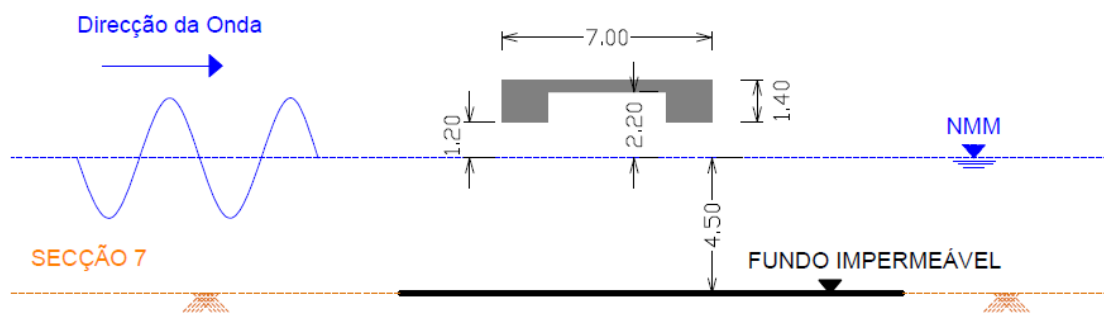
Secção transversal 7 da Ponte-Cais e respetivas dimensões em metros.
